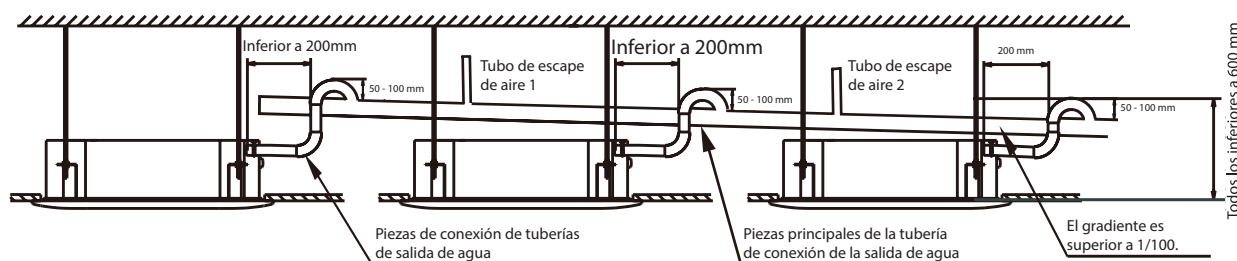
Las tuberías de drenaje de varias unidades se conectan con el alcantarillado a través de la tubería de drenaje principal.
